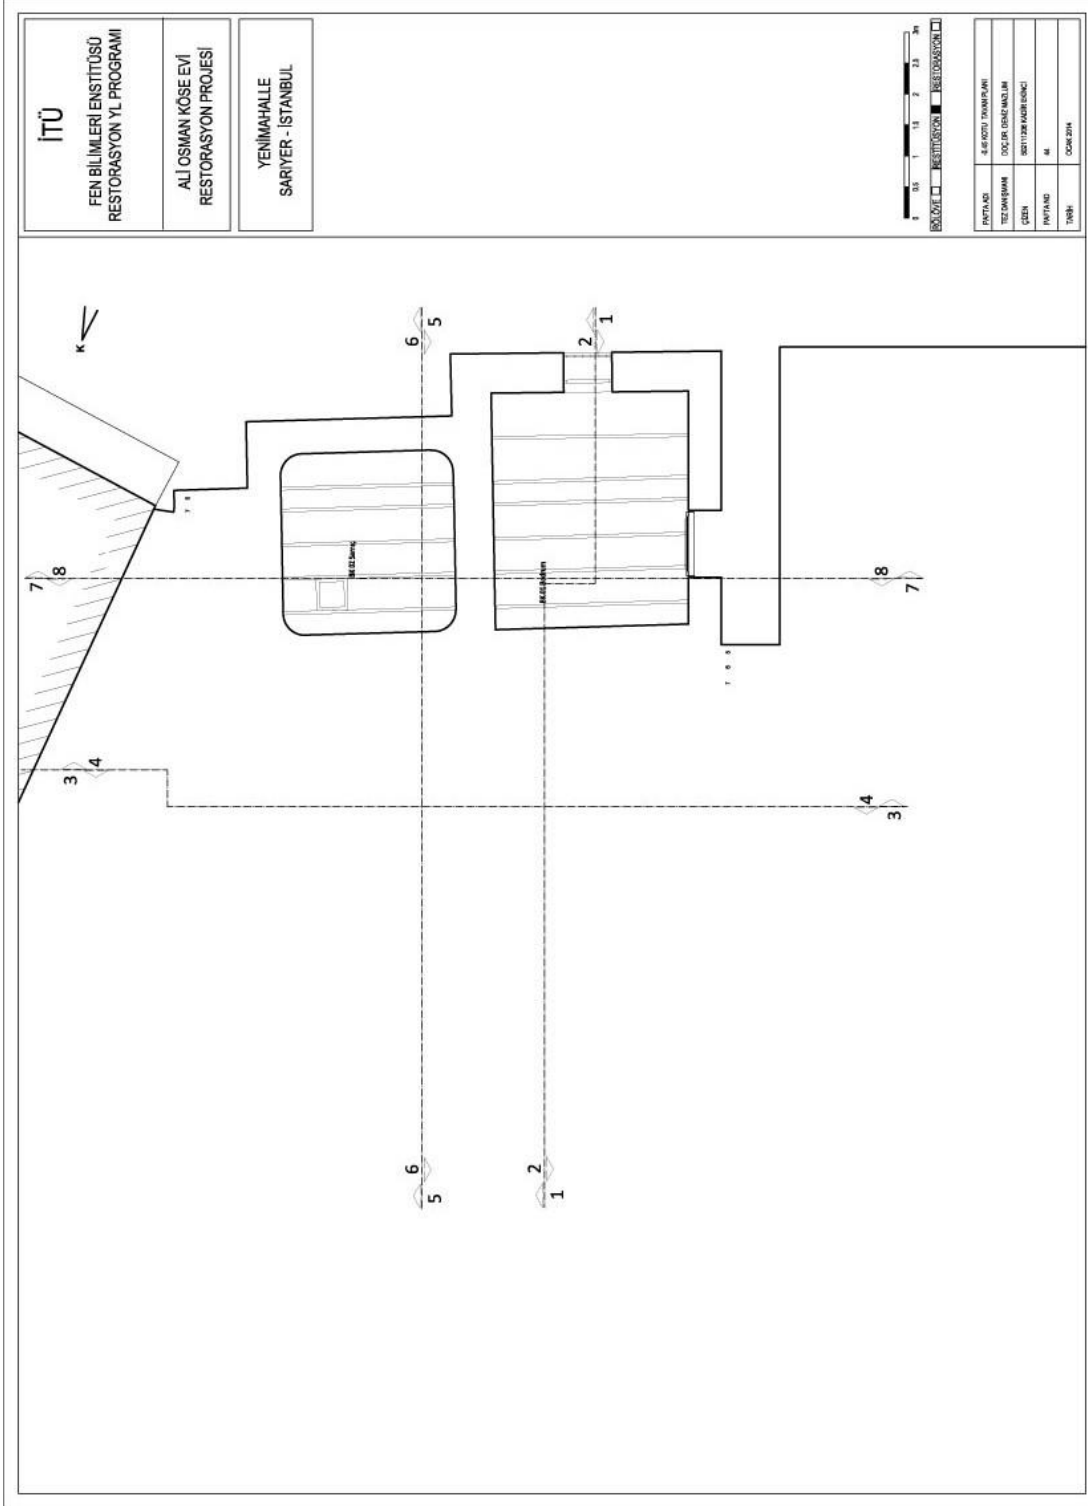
Restitüsyon – +7.75 kotu planı.
